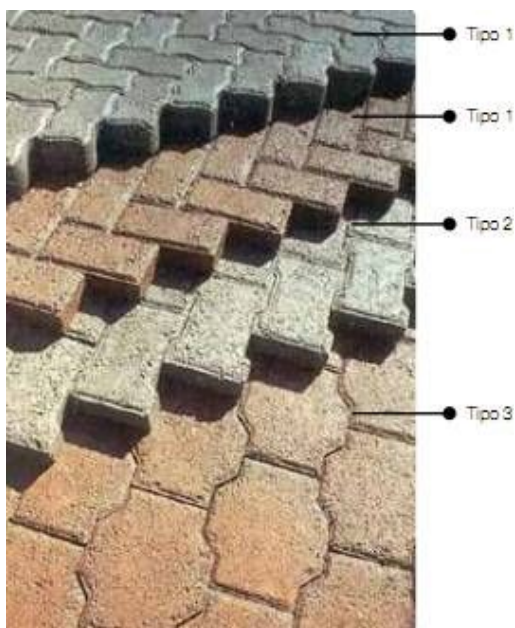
Tipos de Pavimentos Intertravados.
